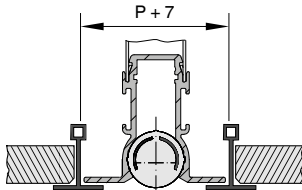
Einbau in T-Profildecke (mit Randverbreiterung), Länge Einbauöffnung mit Endwinkel: $L1 + 29$
